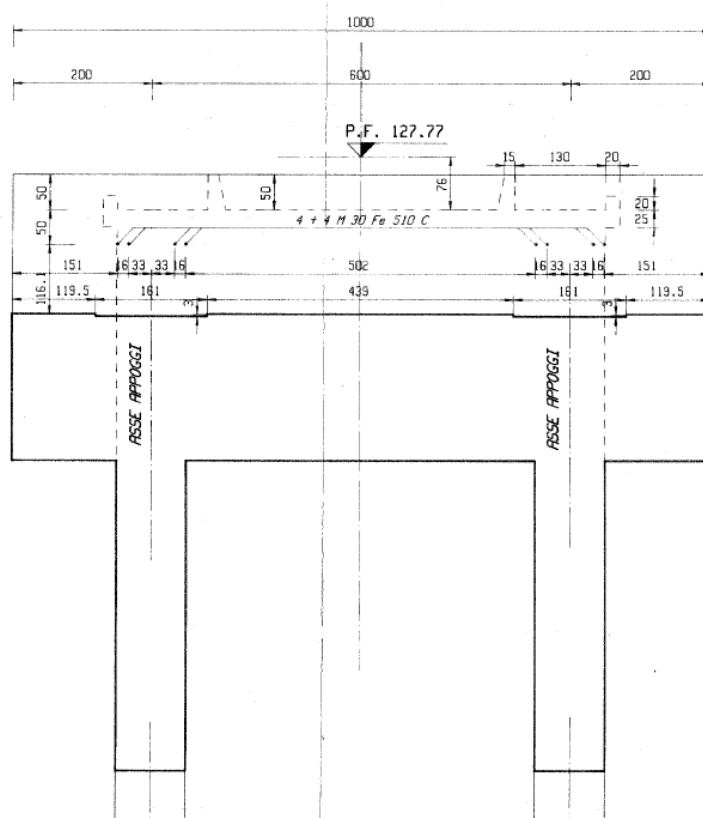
Pianta e prospetto pulvino pile 2 e 3
